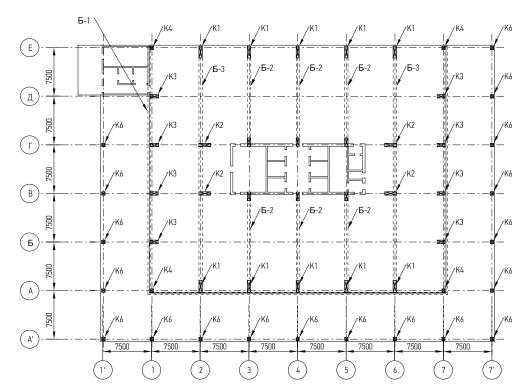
Монолитный железобетонный каркас с балочной системой перекрытия при сетке 7,5х15 м. Маркировочный план несущих конструкций на уровнях 0-2
